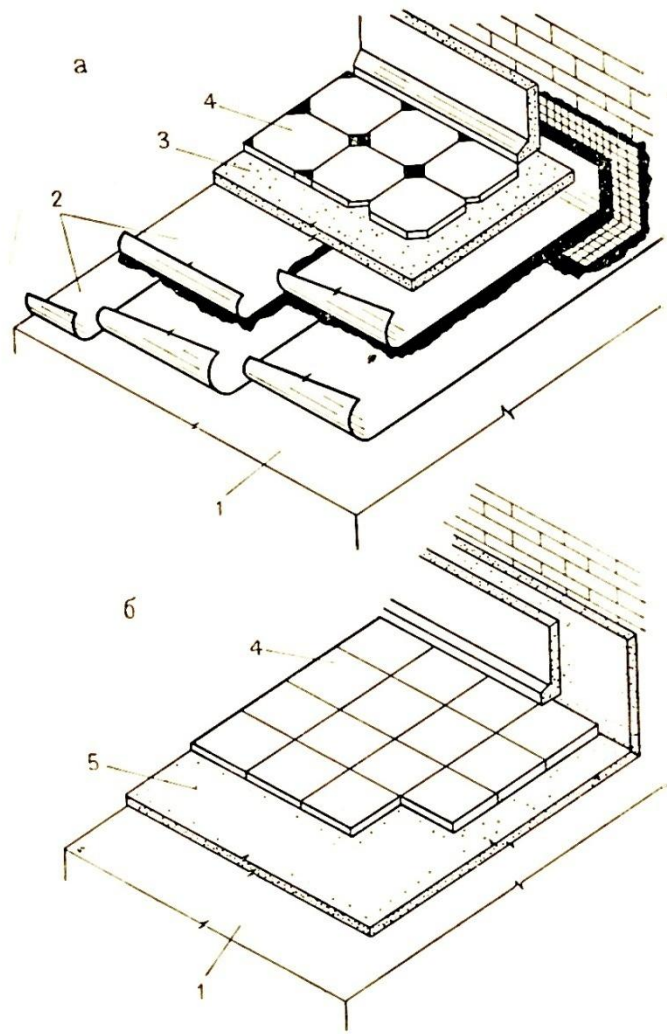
Перекрытия в санитарных узлах и мокрых помещениях
